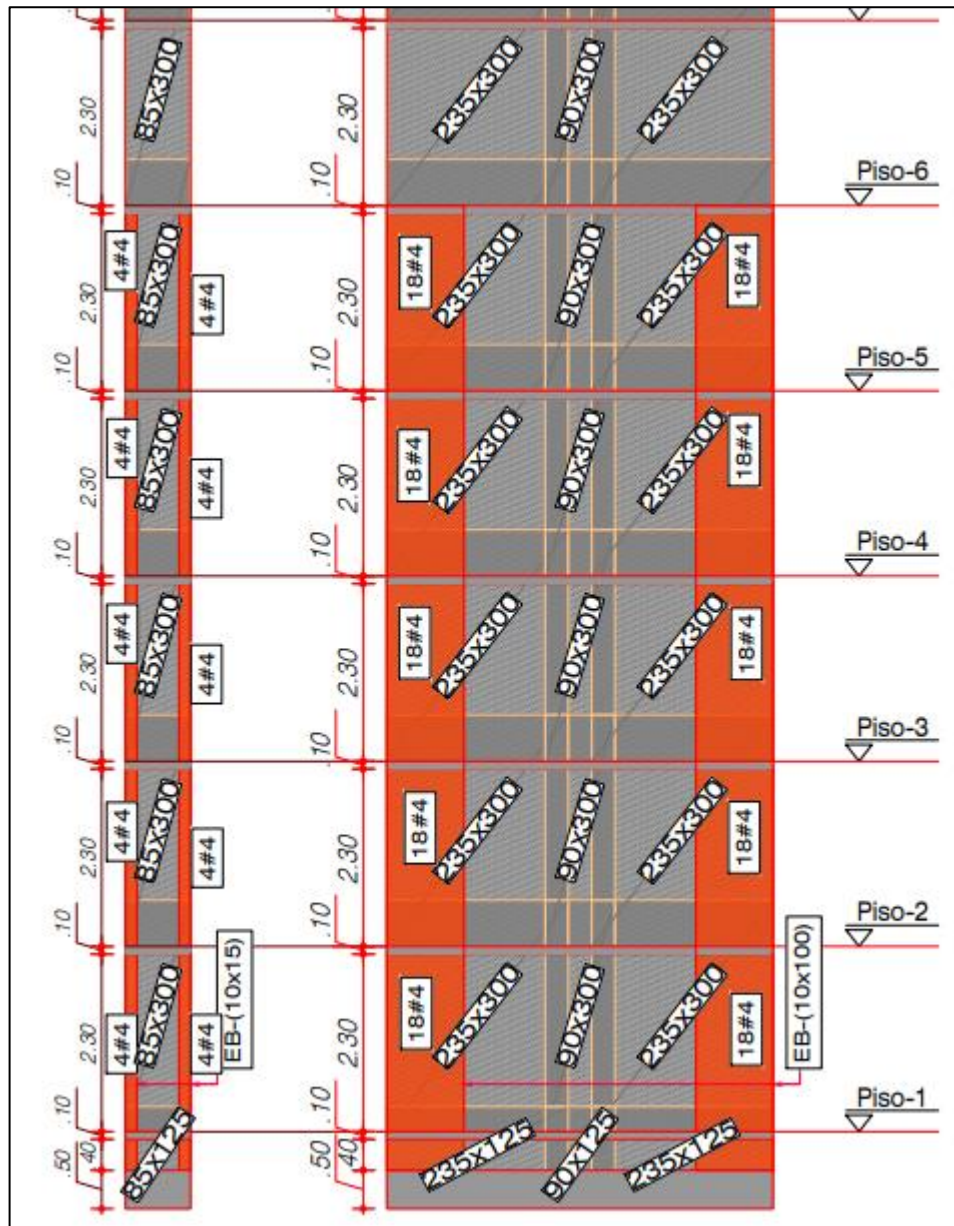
Detalle Muro 13, Sección Elemento de Borde.
